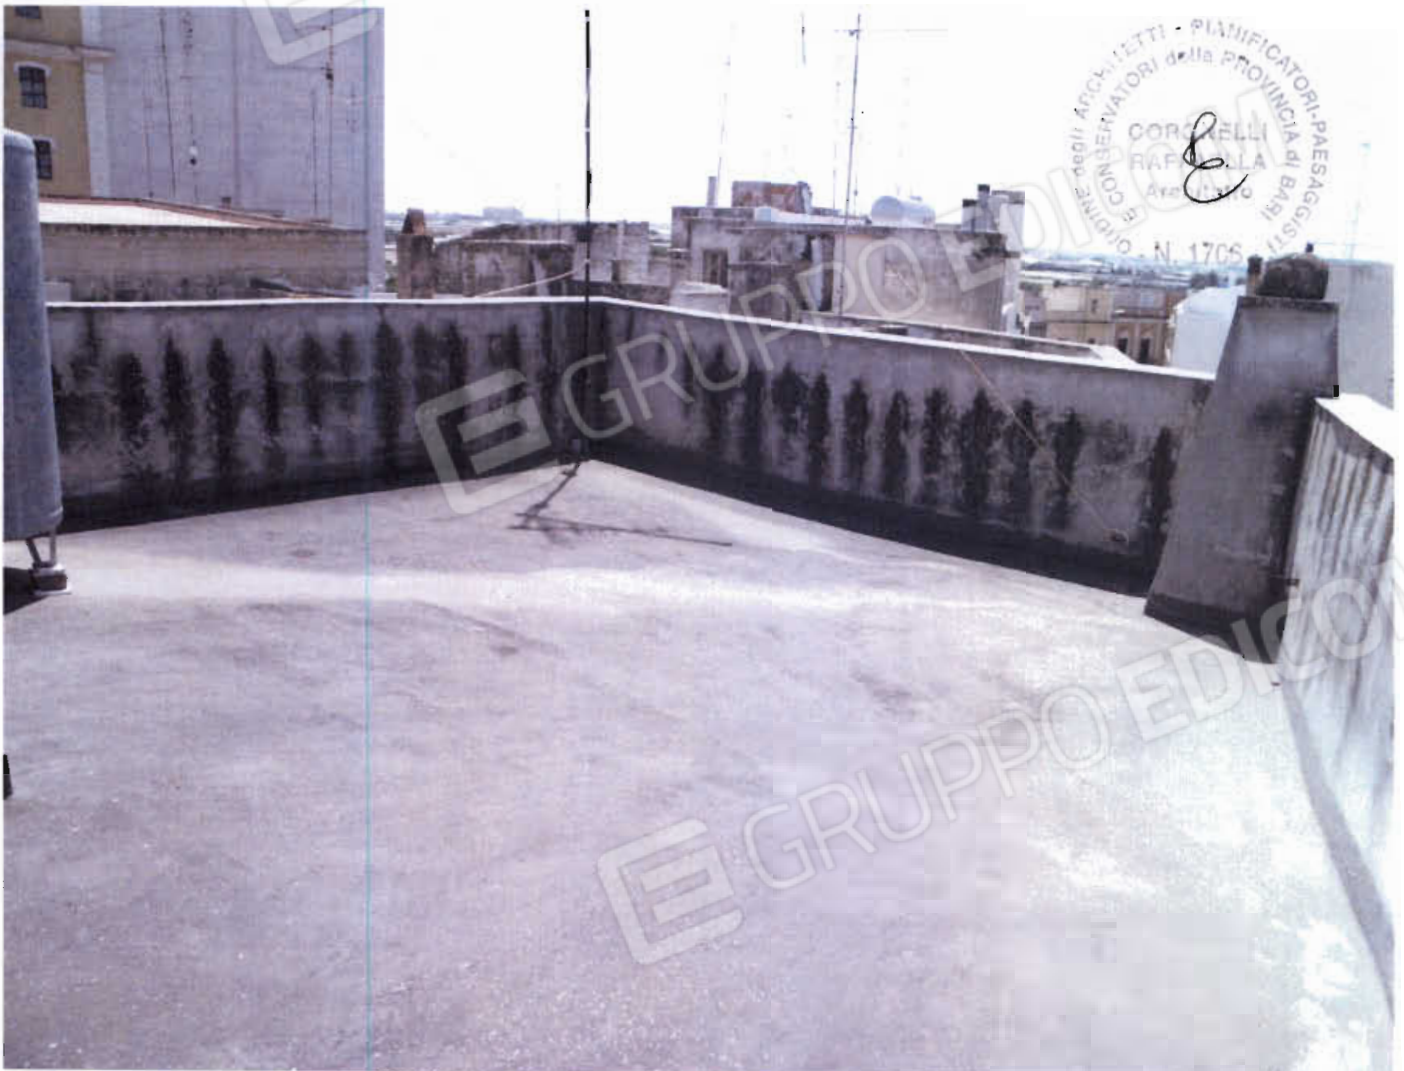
VISTE DAL LASTRICO SOLARE.
